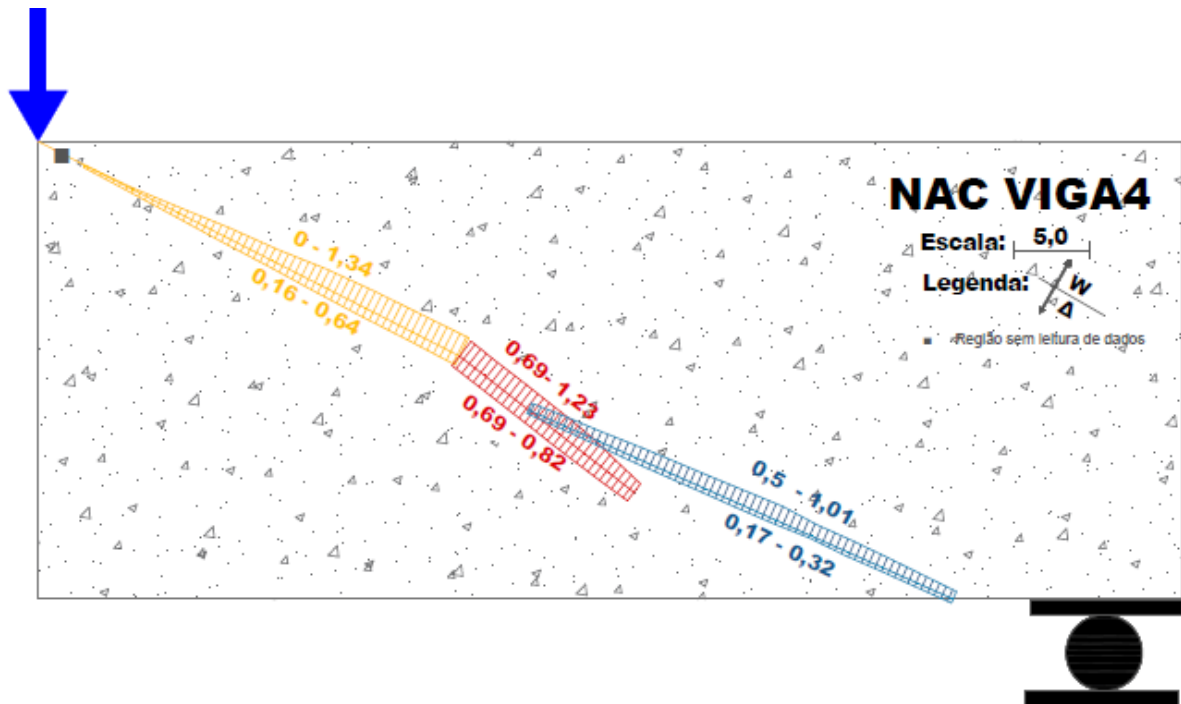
Abertura (w) e deslizamento (Δ) da fissura diagonal crítica da viga NAC-4.
